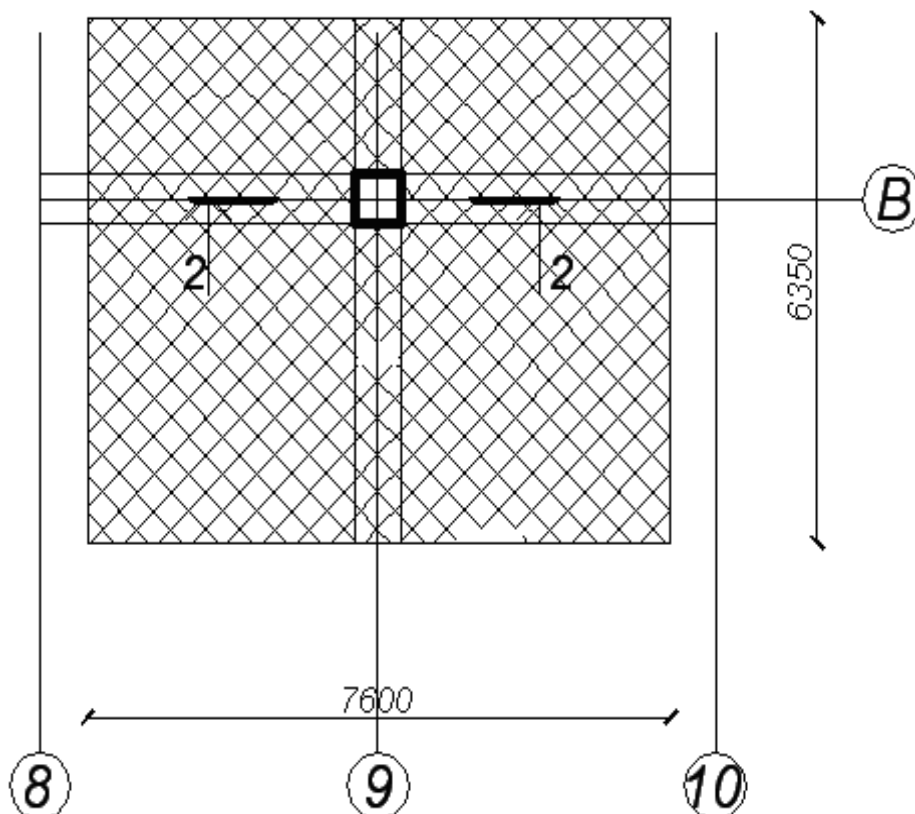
Площа розподілу навантажень на фундамент
